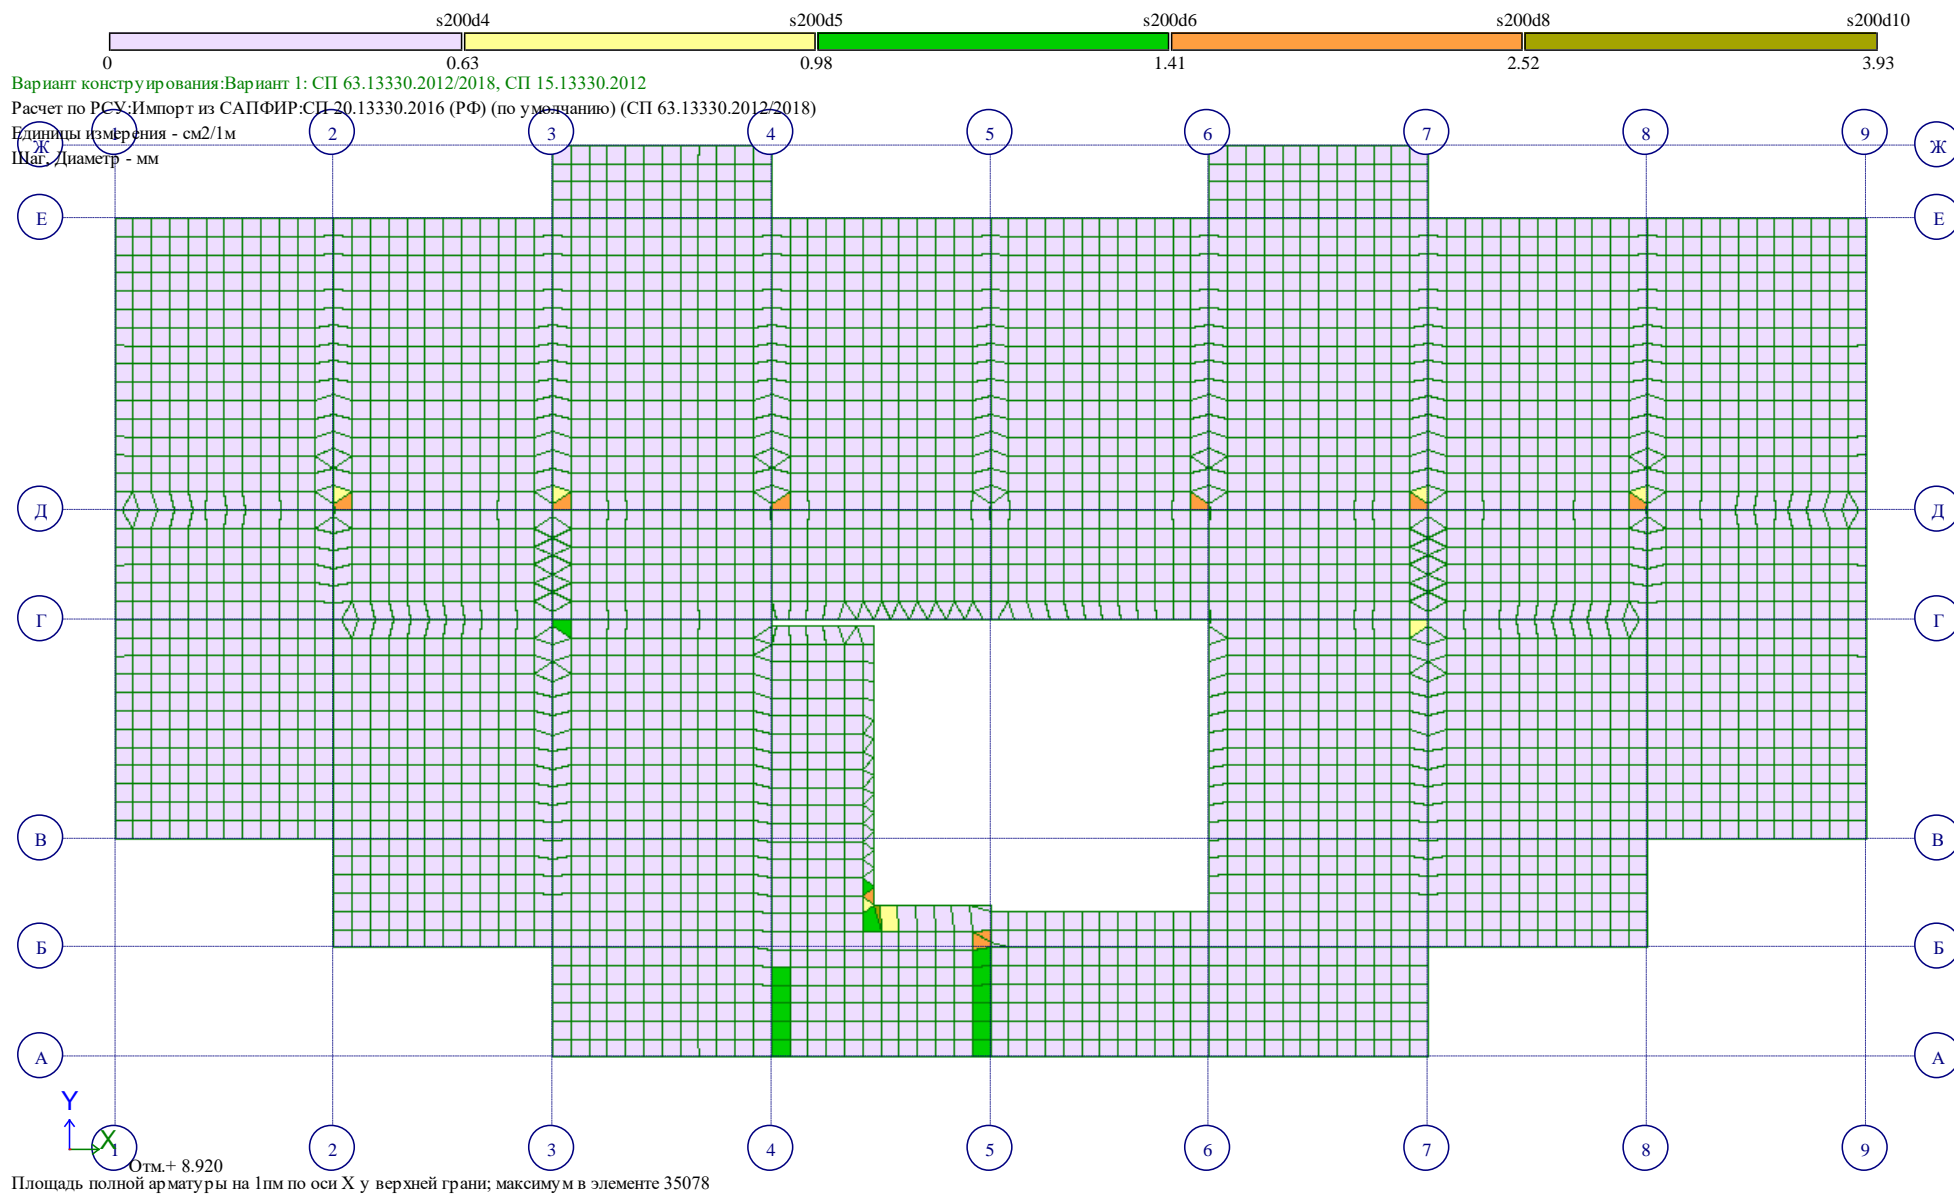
Площадь полной арматуры на 1мм по оси X у верхней грани
